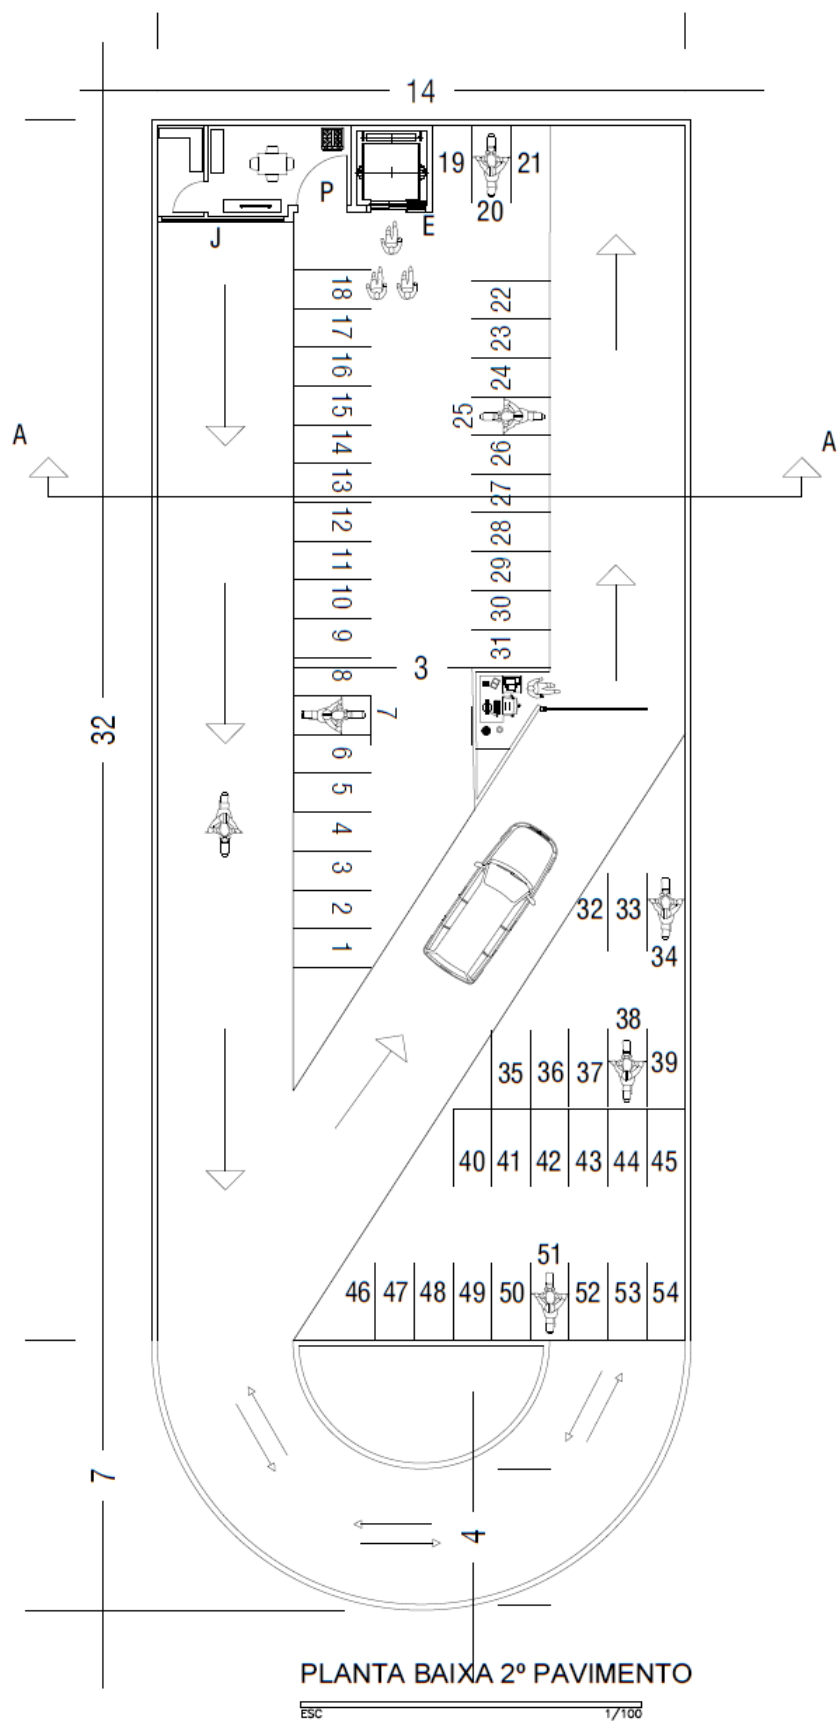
Planta baixa do 2º pavimento do edifício-garagem (medidas em metro).
